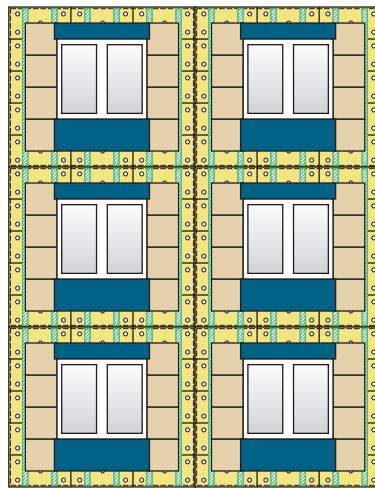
Фрагмент фасада здания, возведенного методом укрупнительной сборки
